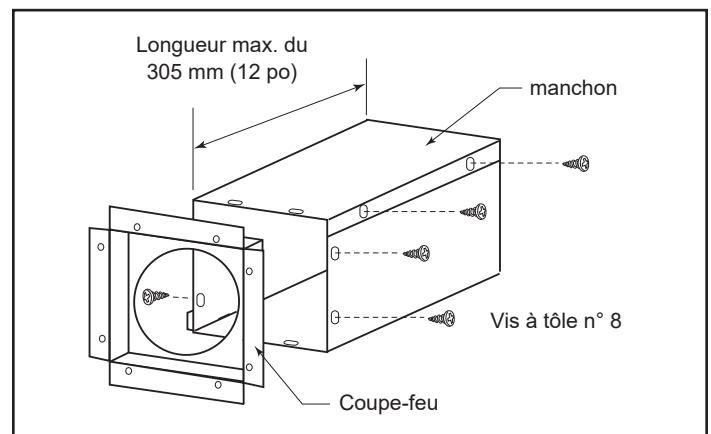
Assembler le manchon et le coupe-feu muraux
